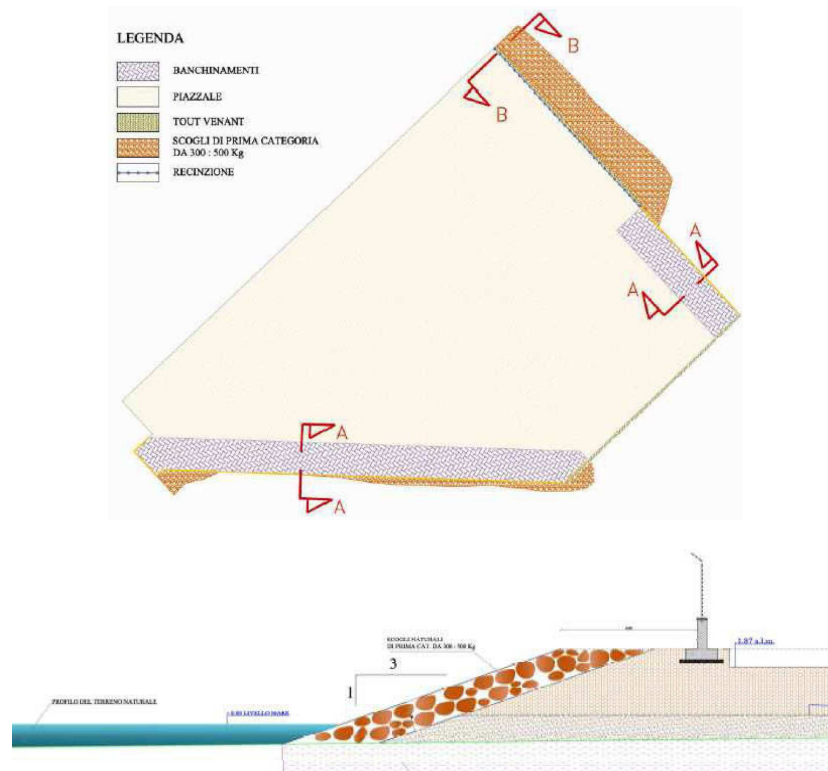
Planimetria piazzali previsti nel progetto definitivo di 2° Stralcio. – Sezione tipo B-B.
